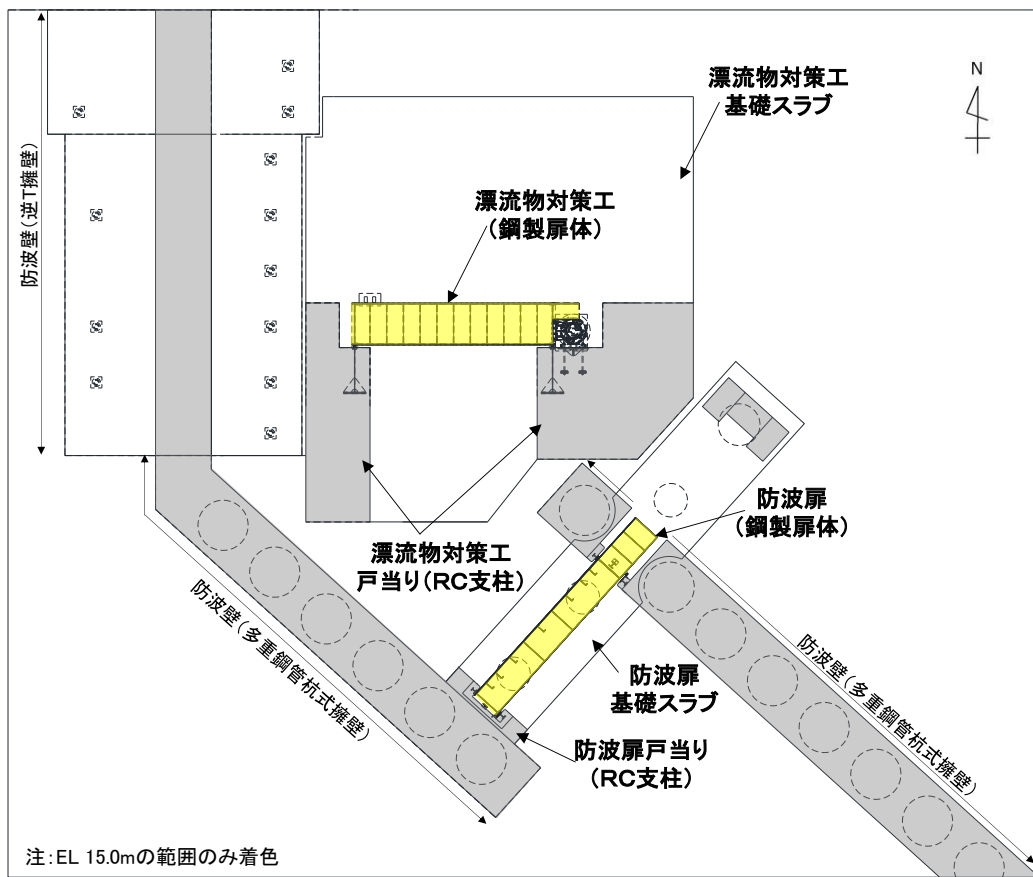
(2) 防波扉 (荷揚場南) の構造概要図 (平面図)
